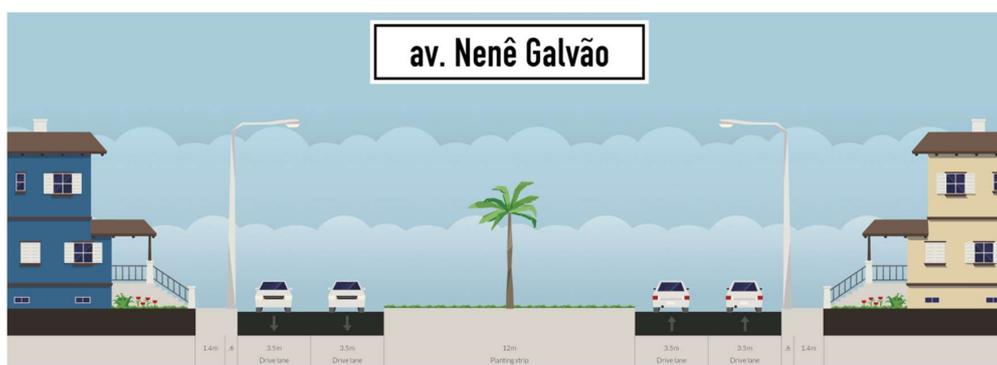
Corte esquemático da Av. Nenê Galvão. Fonte: Street Mix. Elaboração: própria.
